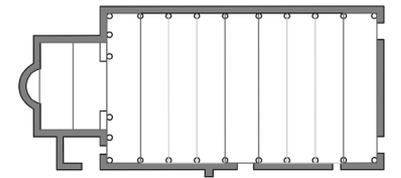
Esquema de luces entre pilares, estructura (Autoría propia, 2021)
